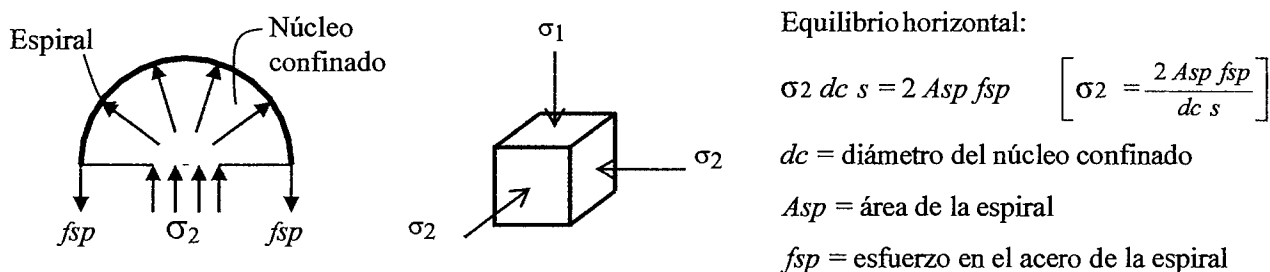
Estado de esfuerzos en el núcleo confinado de una columna.
